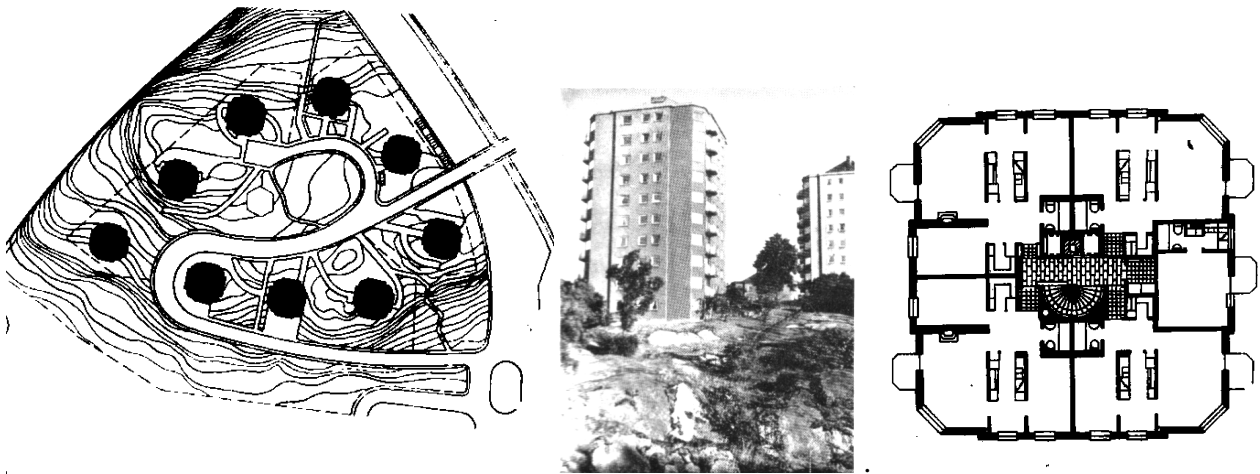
Стокгольм, житловий квартал: генплан, вид житлового будинку, план поверху
